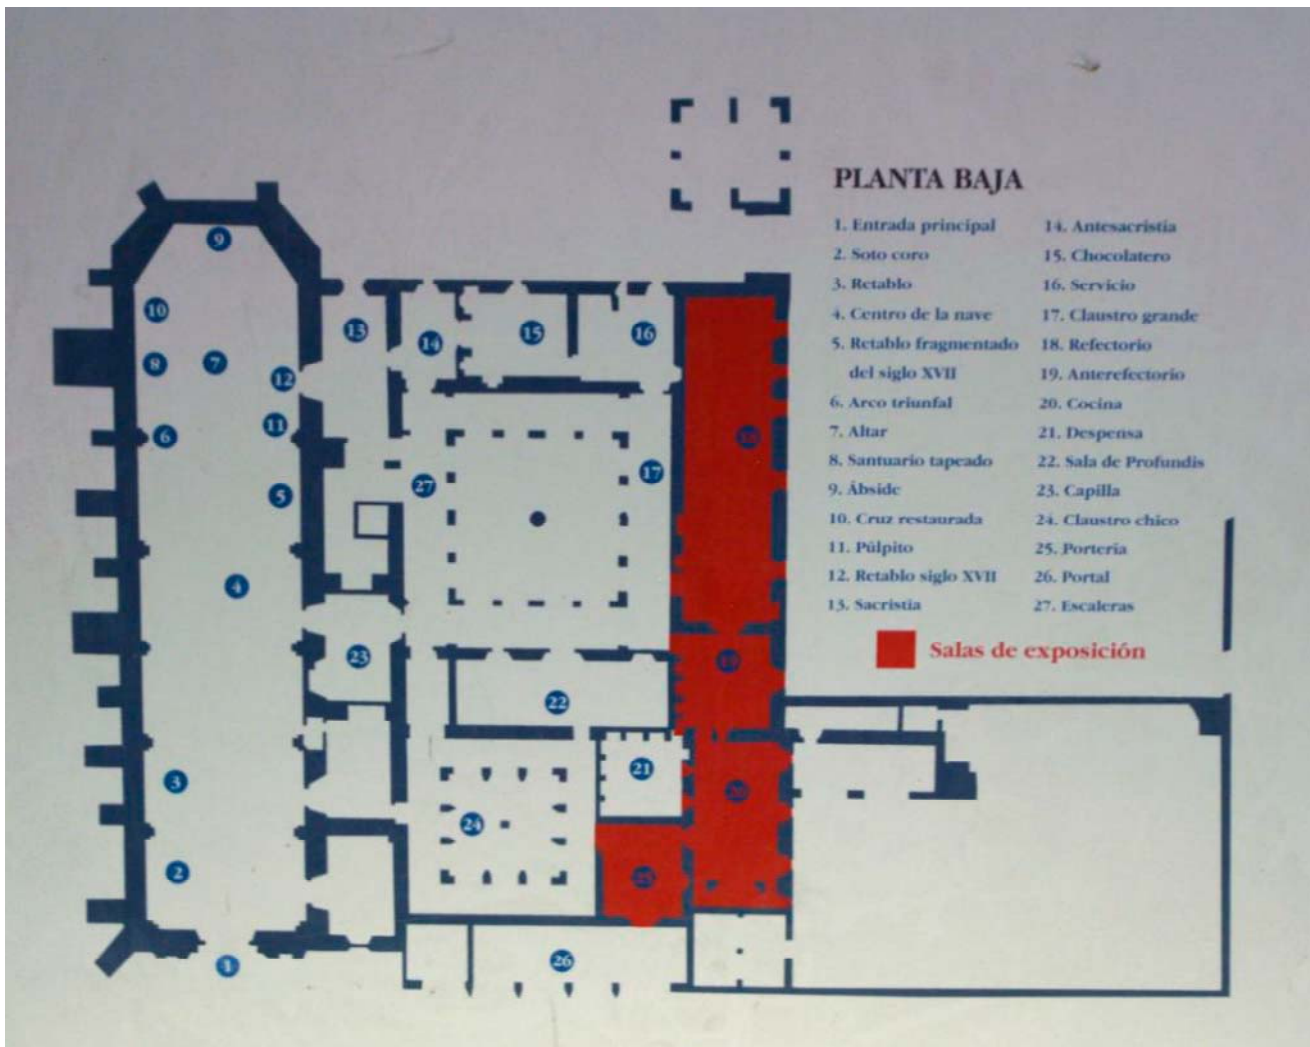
Plano de la planta baja de San Agustín Acolman.
